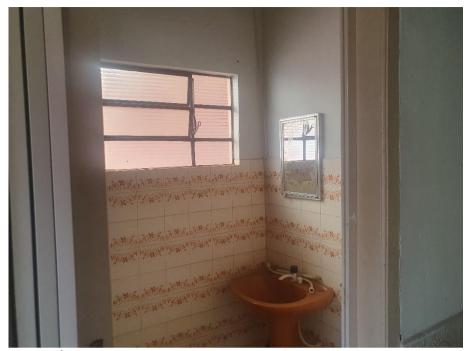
/437 — Banheiro - contendo piso cerâmico vermelho, paredes azulejadas à meia altura restante d paredes rebocadas contendo vaso sanitário e pia.
